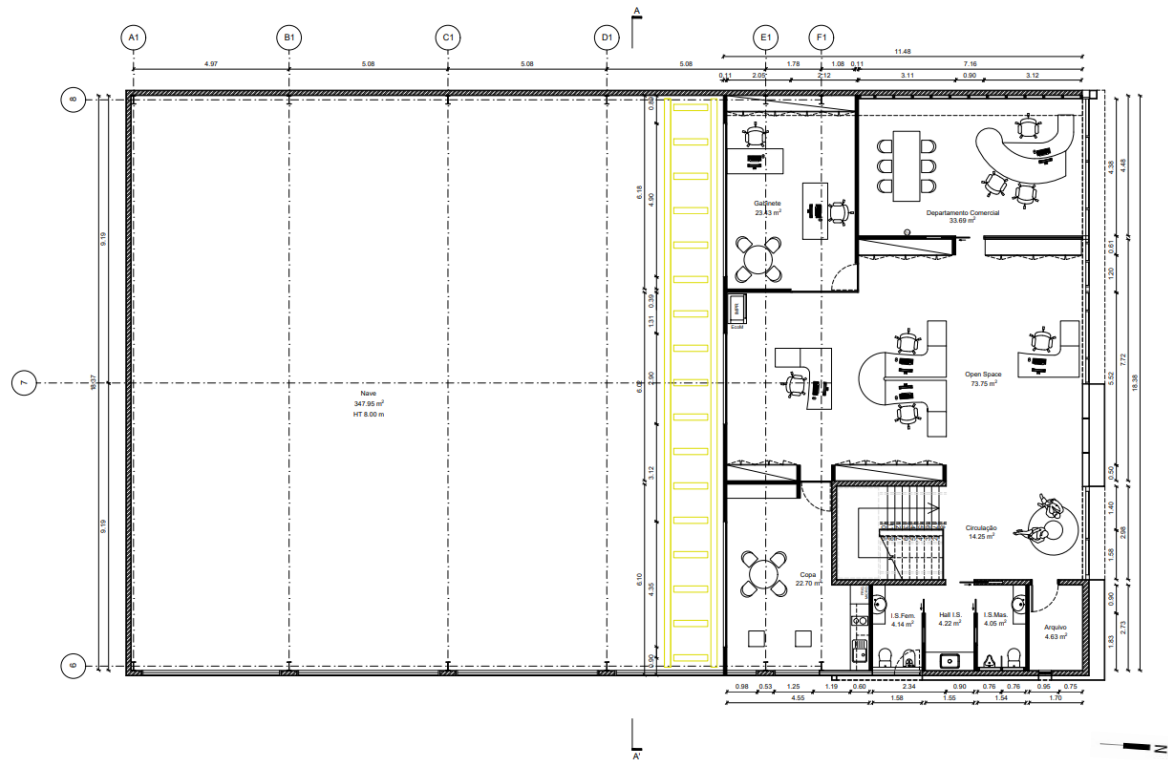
Proposto - Plantas do piso 1 (EXE_R00). Fonte: Garq / Desenvolvimento: Autora.
